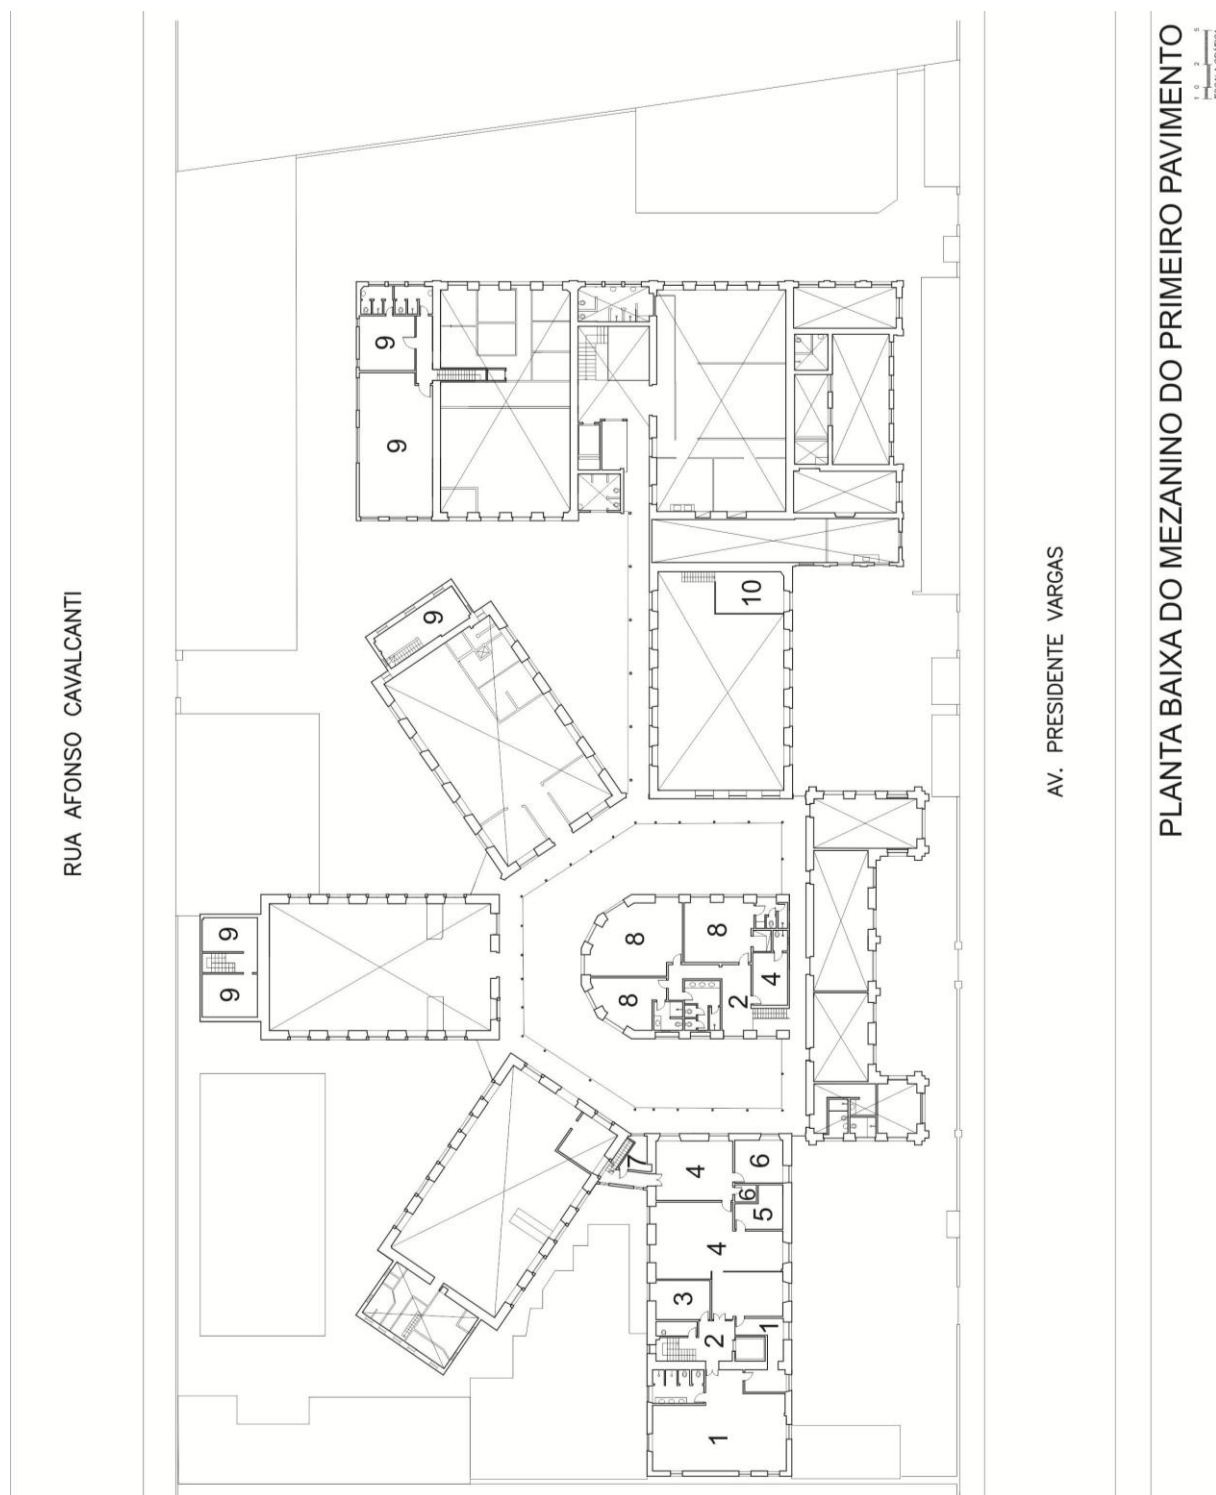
Planta Baixa do Mezanino do Primeiro Pavimento – Usos. Fonte: Plano Diretor, 2004.
